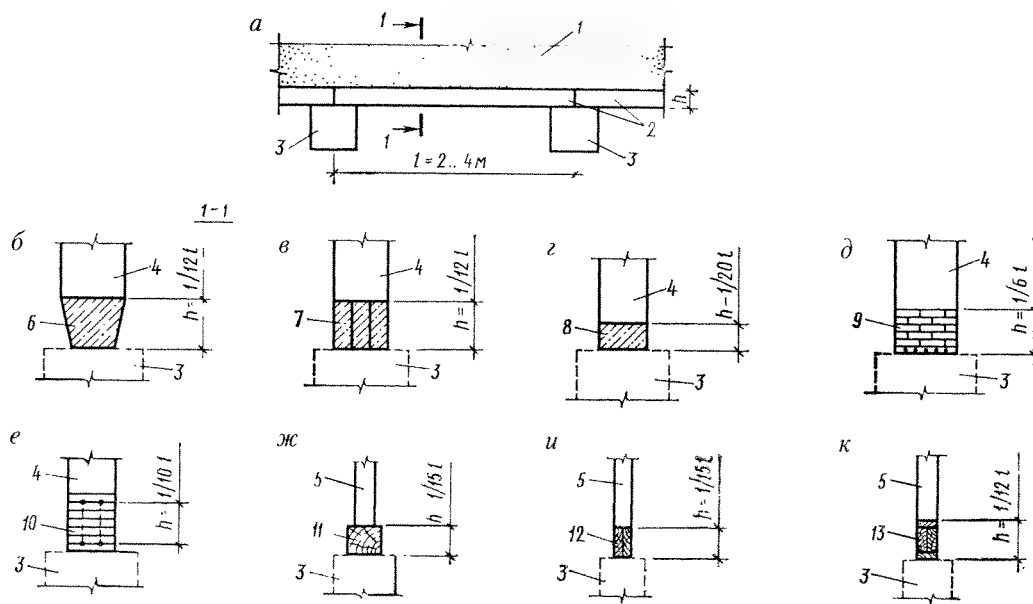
Конструктивные схемы фундаментных балок столбчатых фундаментов: а — фрагмент общего вида столбчатого фундамента; б-е — фундаментные балки под каменные и деревянные стены; ж, и, к — фундаментные балки под деревянные стены; 1 — стена; 2 — фундаментная балка; 3 — столб; 4 — каменная стена; 5 — деревянная стена; 6 — сборная железобетонная фундаментная балка; 7 — сборные железобетонные перемычки, балочные, усиленные; 8 — монолитная железобетонная балка; 9 — рядовая армированная кирпичная балка; 10 — армированная кирпичная балка со стальными каркасами в вертикальных швах кладки; 11 — деревянная балка; 12 — то же, из брусков; 13 — то же, составная из досок
